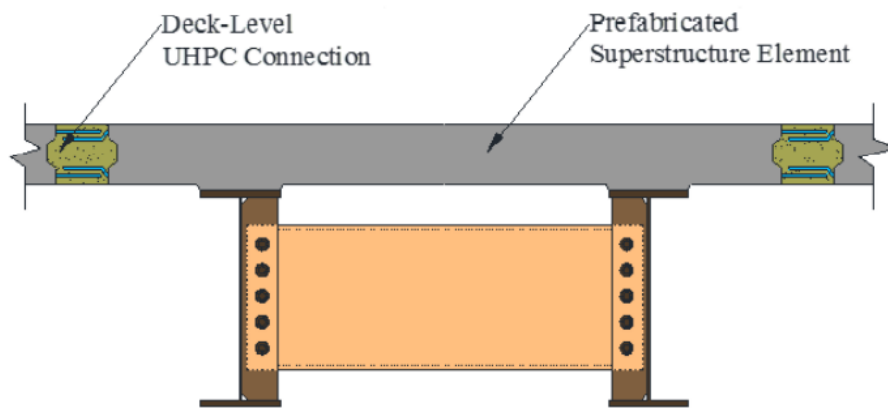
Ligações realizadas com UHPFRC entre elementos modulares da superestrutura [19].
